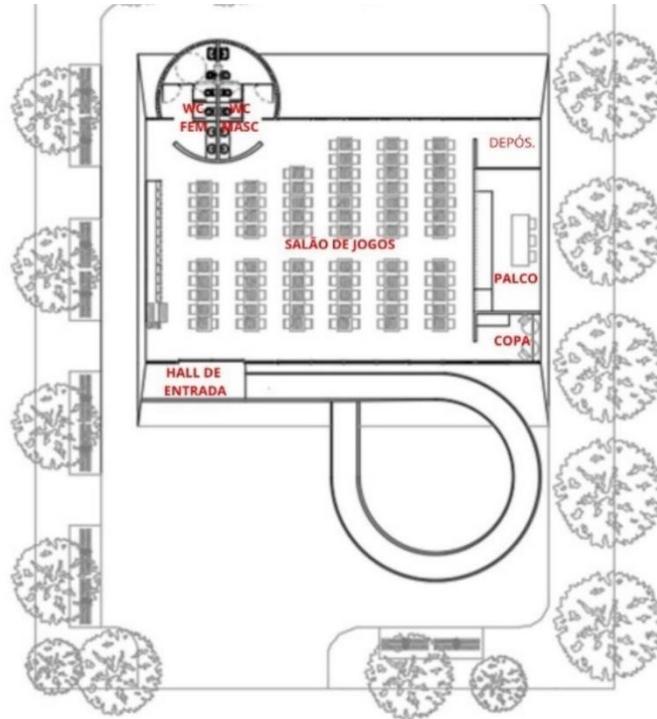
Estudo de planta do pavimento superior com a alocação de ambientes
